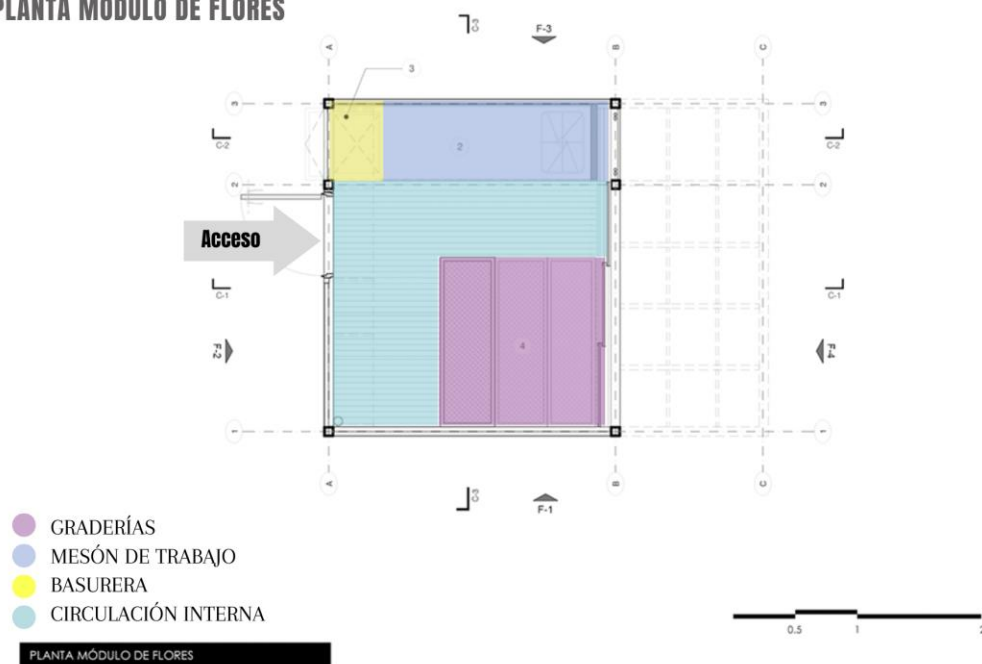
Planimetría general y distribución espacial extraída – referente 1
